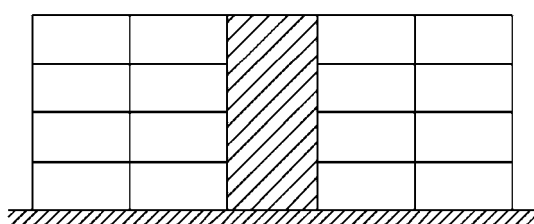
Estructuras con núcleos de hormigón o muros de hormigón
